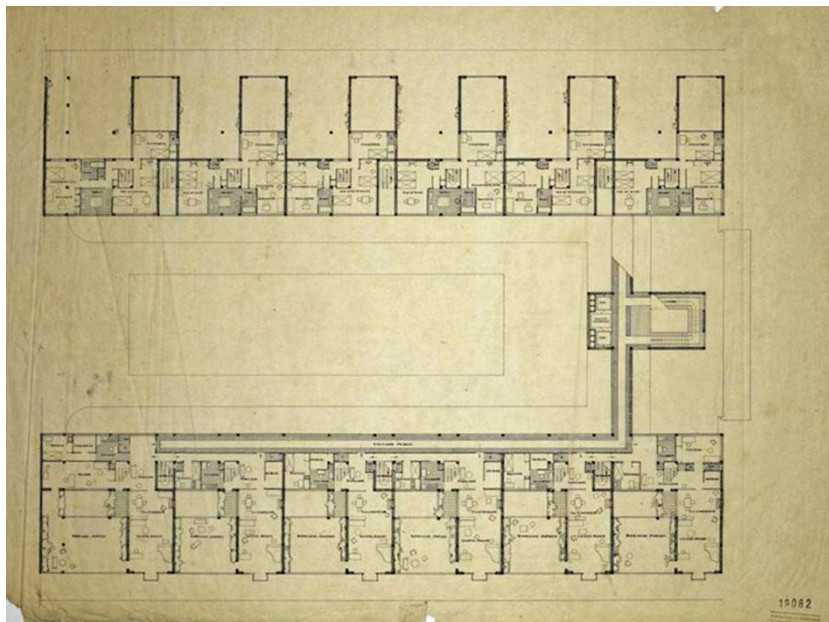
Planta tipo dos immeubles villas. FONTE: <http://www.fondationlecorbusier.fr>
